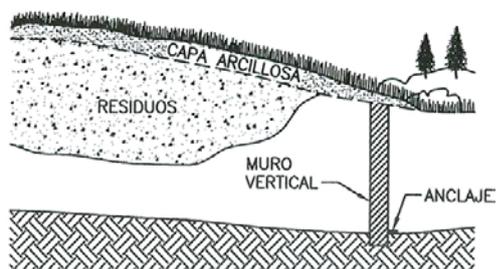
Anclaje de un muro vertical (USEPA, 1984).
